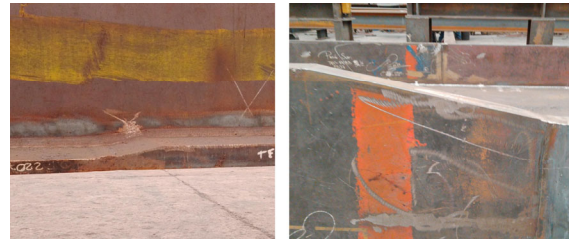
Detalles de transiciones suaves. Transición de espesor, lado izquierdo, y transición de ancho en ala inferior, lado derecho.
